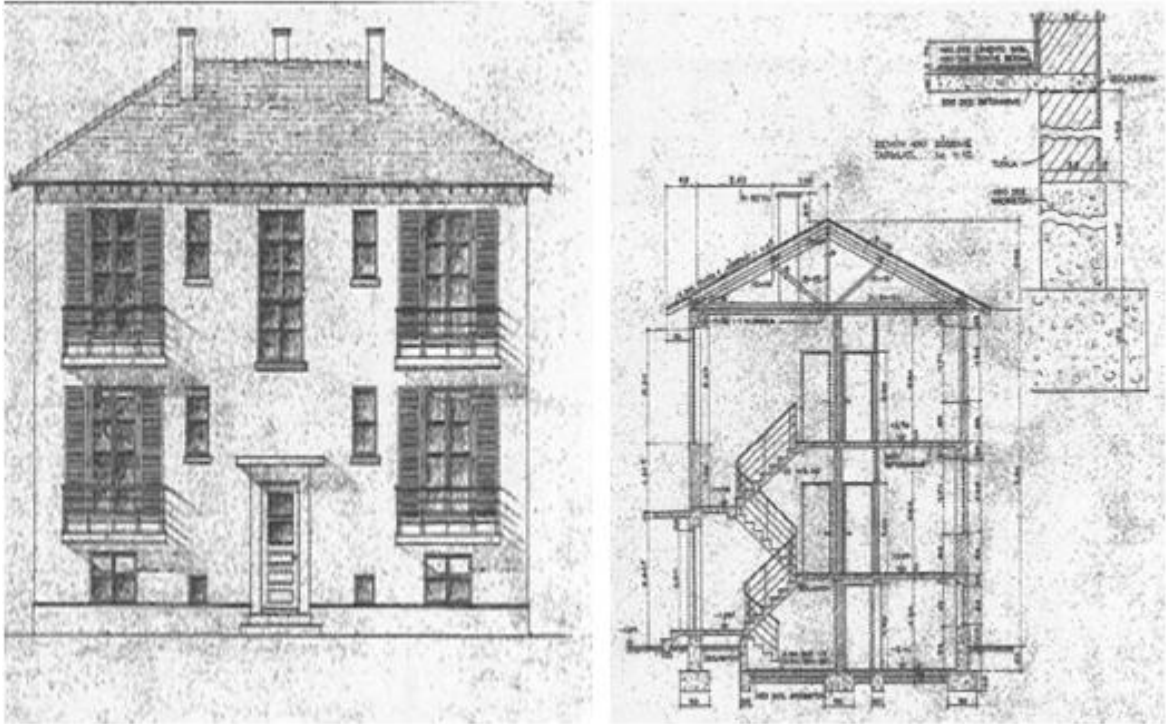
Nazilli Basma Fabrikası bekâr amele pavyonları tadilat planı 04.12.1940 (Doğan, 2009: 96).
